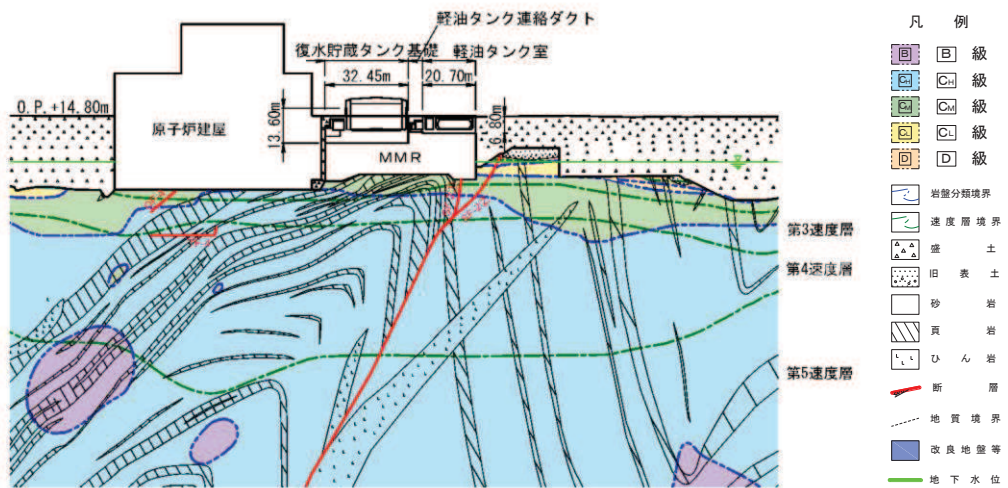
分類 a (MMR) 評価断面図 (軽油タンク室の南北断面)
